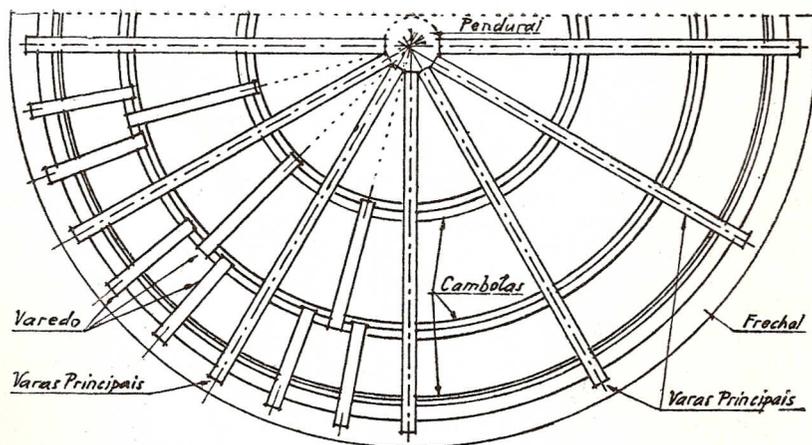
PLANTA DA ESTRUTURA DA CÚPULA
